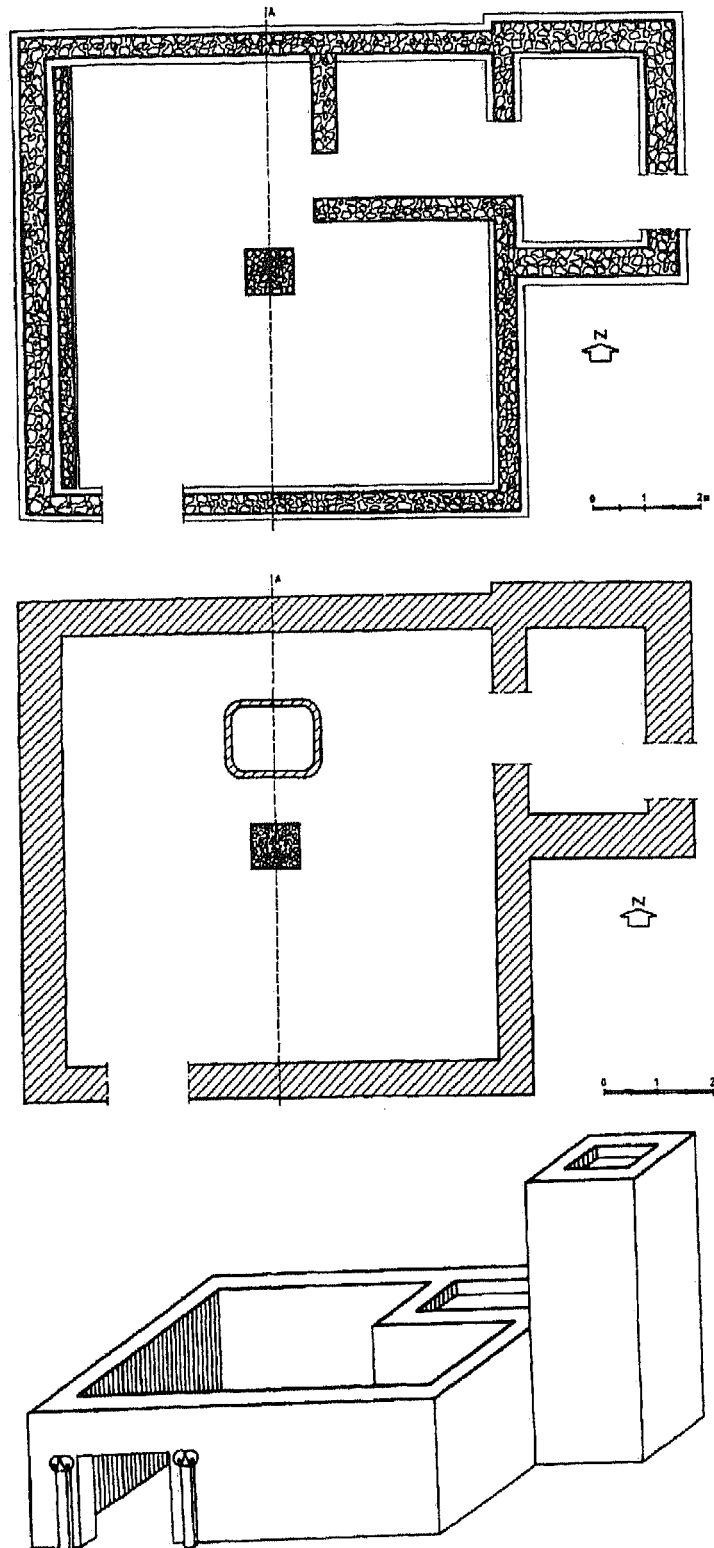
Arriba: planta del templo de La Alcudia de Elche, fase A; centro: planta de la fase B; abajo: reconstrucción hipotética (según Ramos Fernández).
